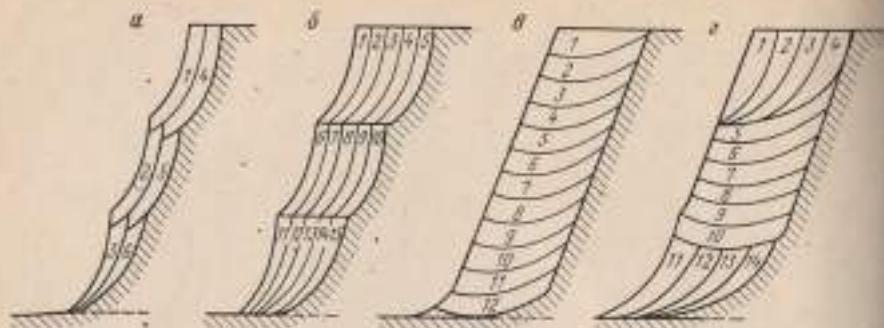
Способы откатки лобов роторными экскаваторами
